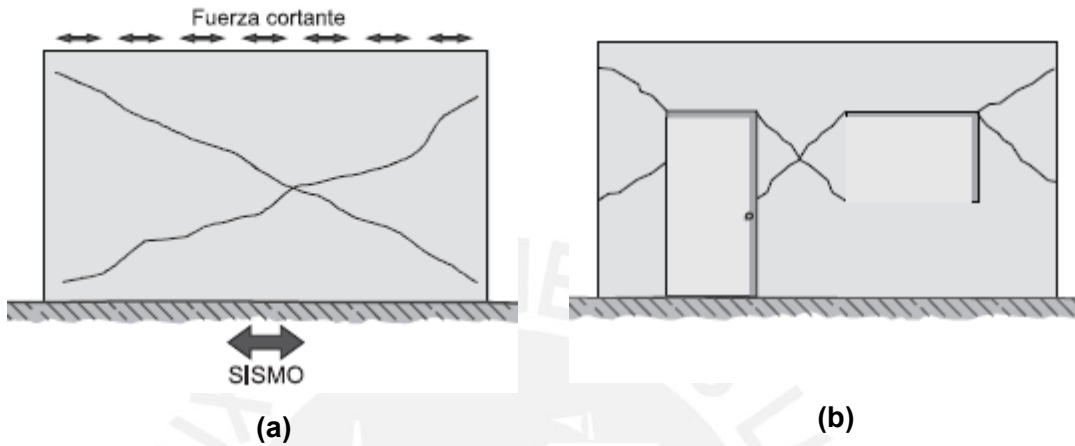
Grietas diagonales debidas a fuerzas en el plano del muro (Fuente: PNUD, 2008)
